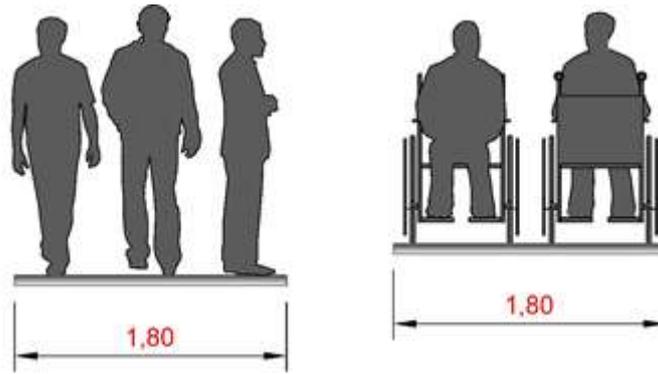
Sección de acera mínima exigida por normativa. Fuente: DOYMO.
